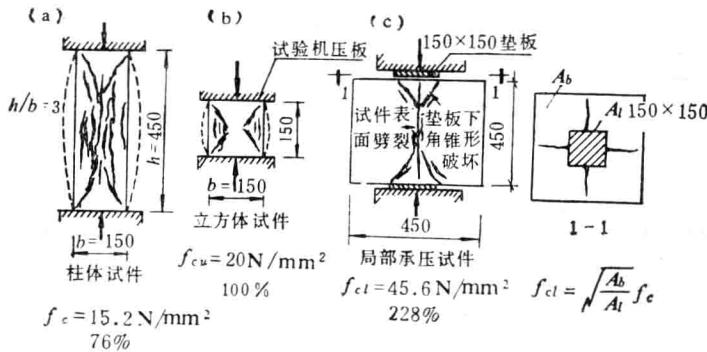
三种外形尺寸的混凝土轴心受压试件 (单位: mm)
